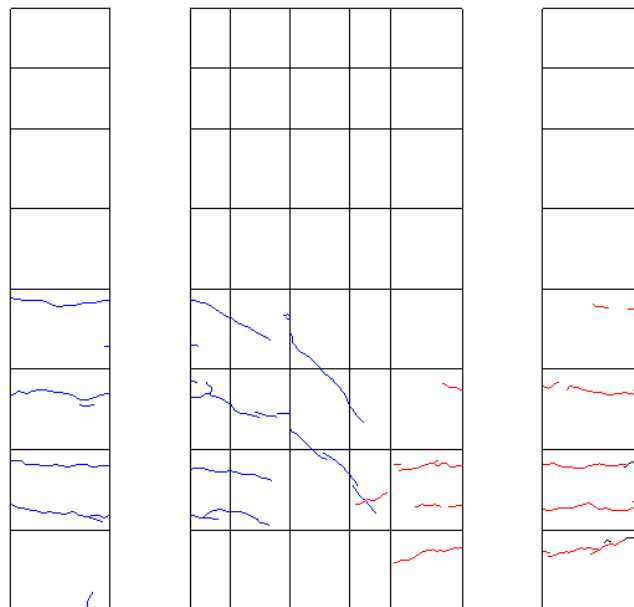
R=1/400 ひび割れ図
